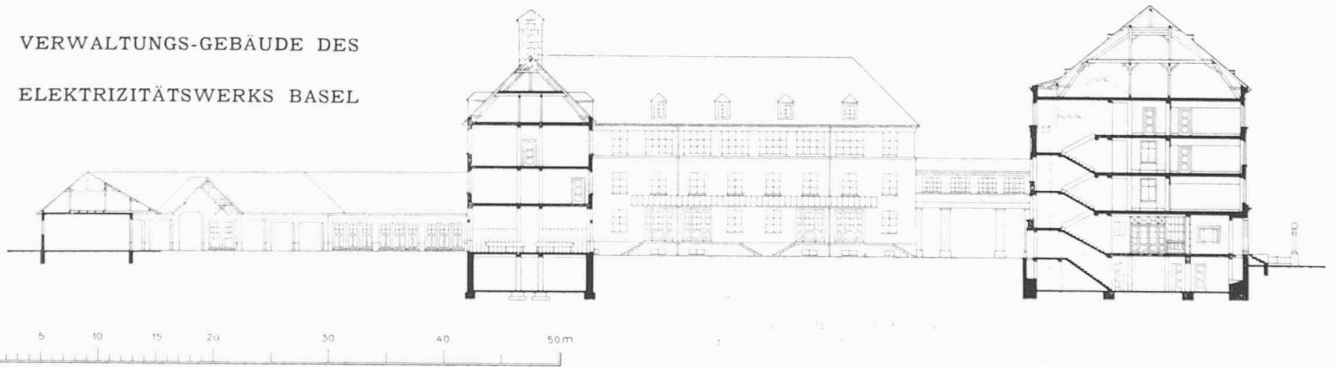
Erdgeschoss-Grundriss, Abb. 2 Schnitt der Gesamtanlage. — Masstab 1 : 600. — (Text hierzu Seite 141.)
